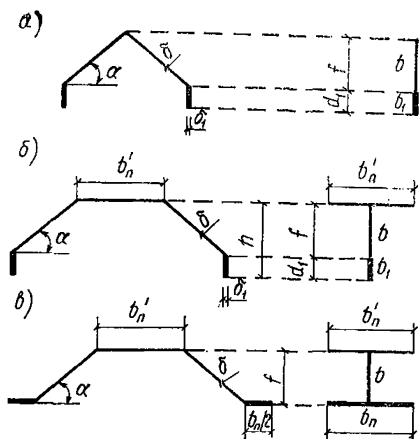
Схемы поперечных сечений складок и их приведение для расчета а — к прямоугольным сечениям; б — к тавровым сечениям; в — к двутавровым сечениям
